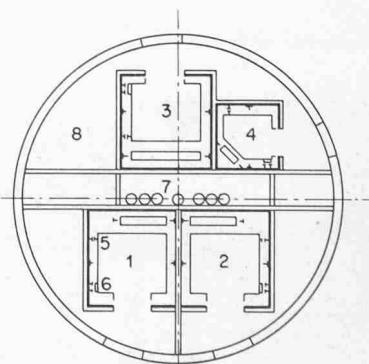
Grundriss des Fernsehturmes, schematisch
